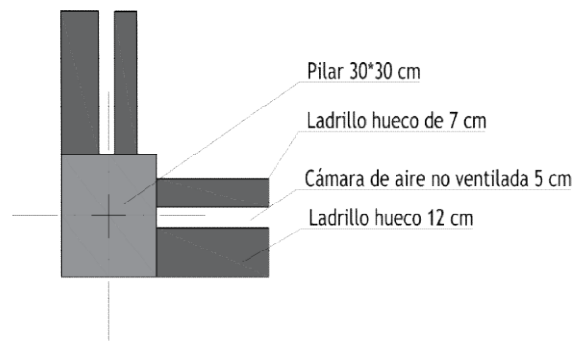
Hipótesis sección pilar encuentro con fachada (Fuente autor).
